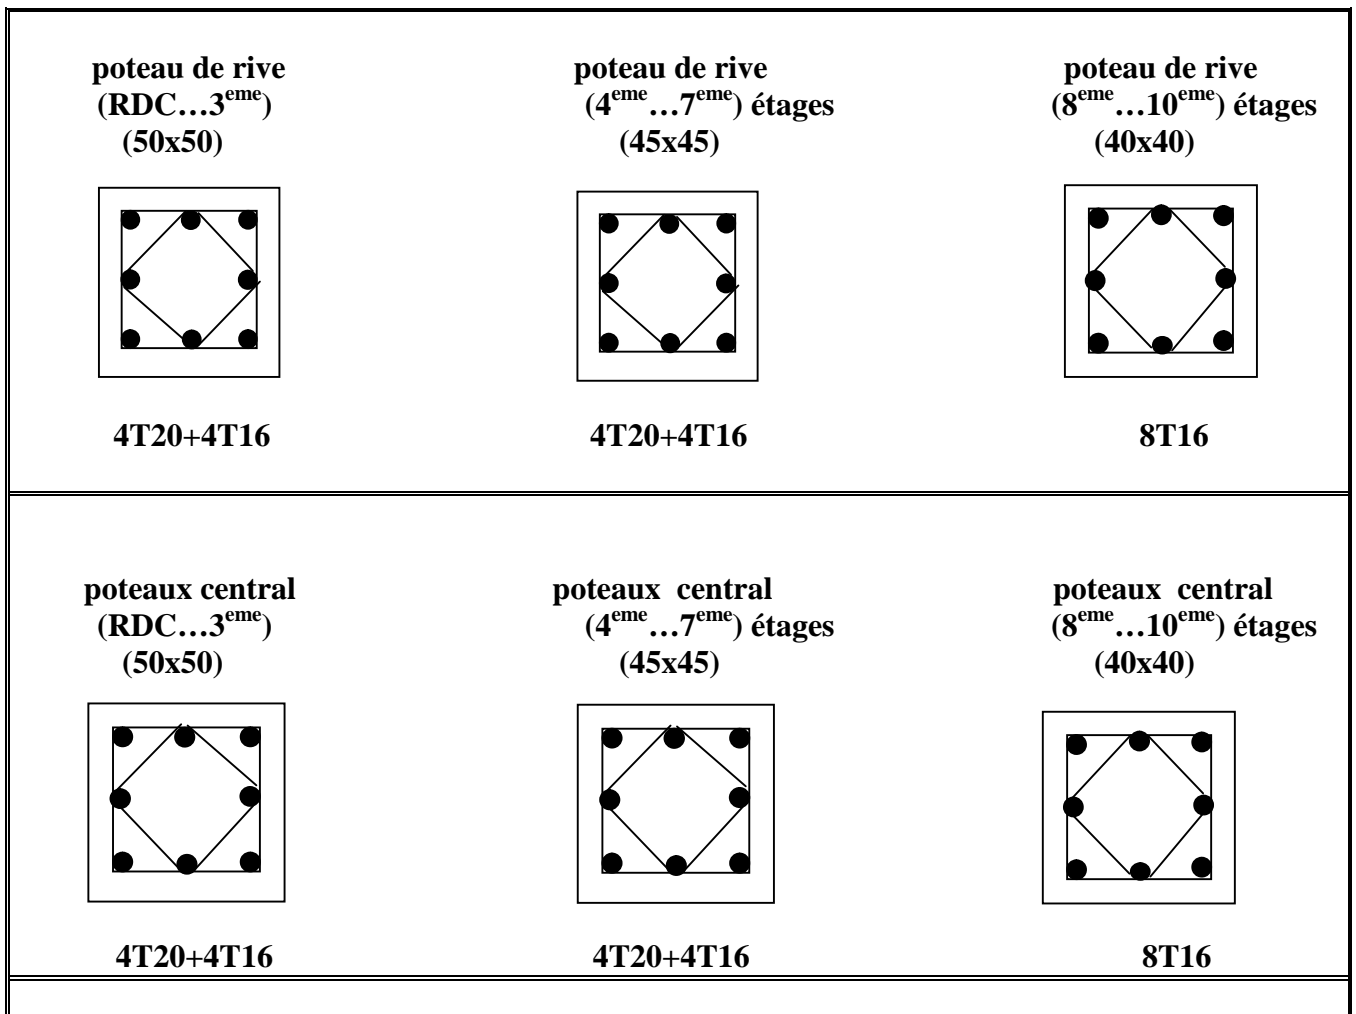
Dessin de ferrillages des sections des poteaux
